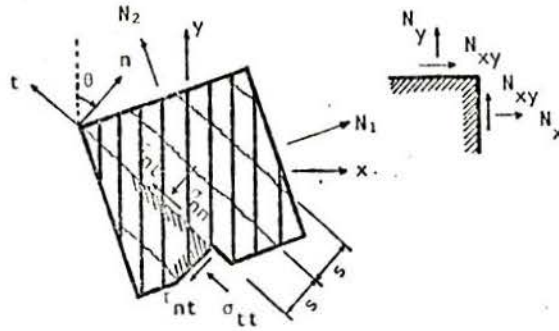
Elemento de concreto armado fissurado
